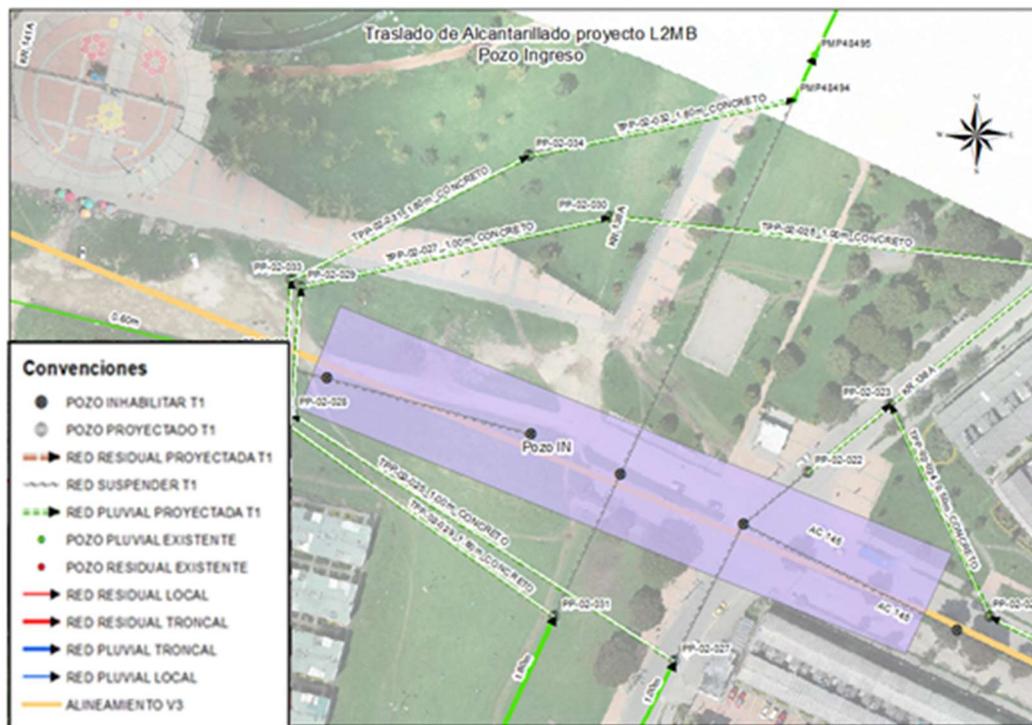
Traslado de redes de Alcantarillado Pozo de Entrada Carrera 138A con Calle 145 Red Pluvial
